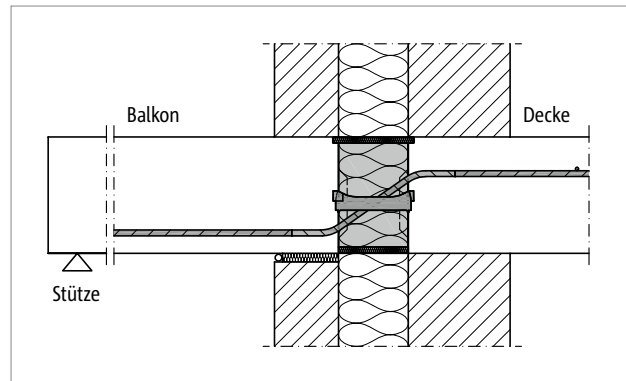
Schöck Isokorb® XT Typ QL: Anschluss bei zweischaligem Mauerwerk mit Kerndämmung (XT Typ QL-V5 bis V8)
